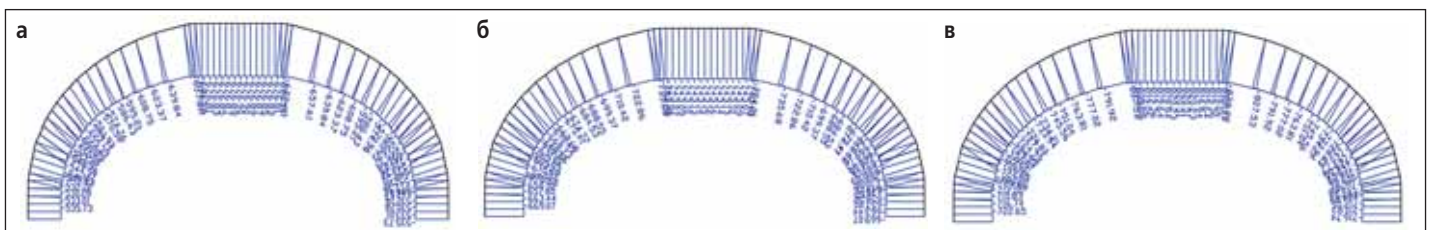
Полученные эпюры продольных сил от воздействия, кН: а – собственного веса конструкции, окружающего грунта и дорожного покрытия; б – собственного веса конструкции, окружающего грунта, дорожного покрытия и автомобильной нагрузки АК, в – собственного веса конструкции, окружающего грунта, дорожного покрытия, автомобильной нагрузки АК, а также от сейсмической нагрузки
